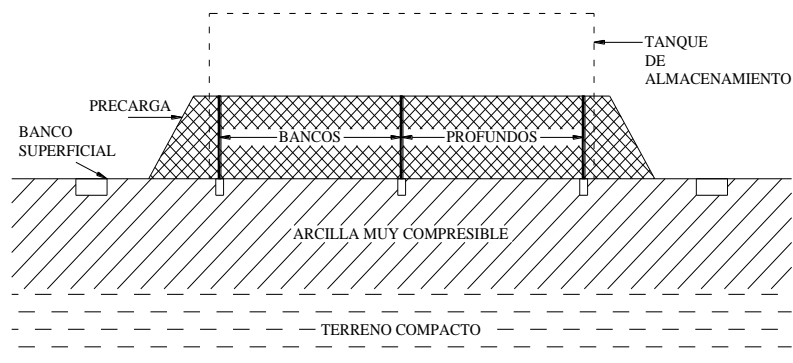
Empleo de precargas para la consolidación previa del terreno (Ketty, 2003).
